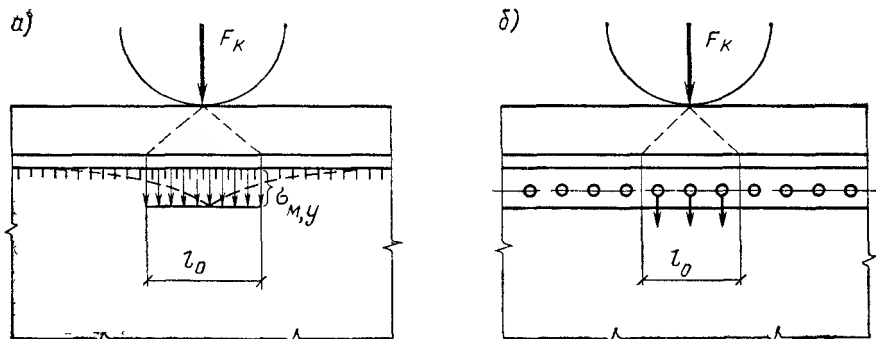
Местные напряжения в стенке подкрановых балок под колесом крана
